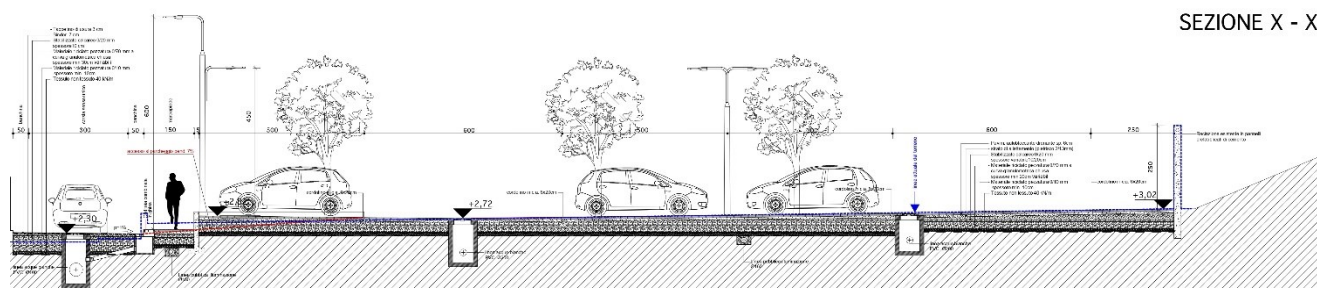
Sezione X-X' nuovo parcheggio zona B1.7
